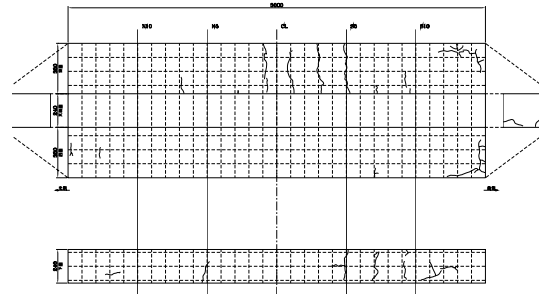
ひび割れ発生状況 (Level 2 供試体)
